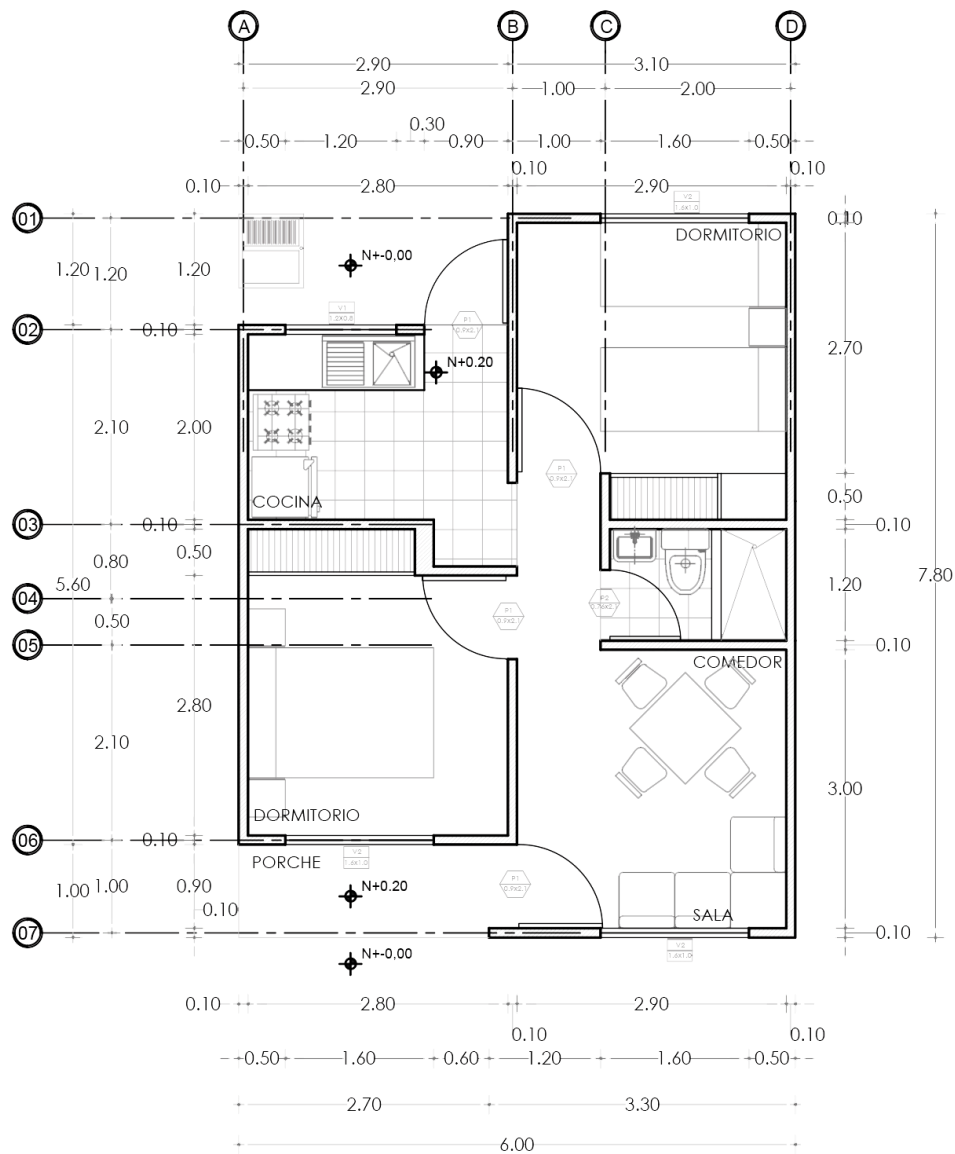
Distribución en Planta Muros Portantes Reforzados. NEC-SE-VIVIENDA.
